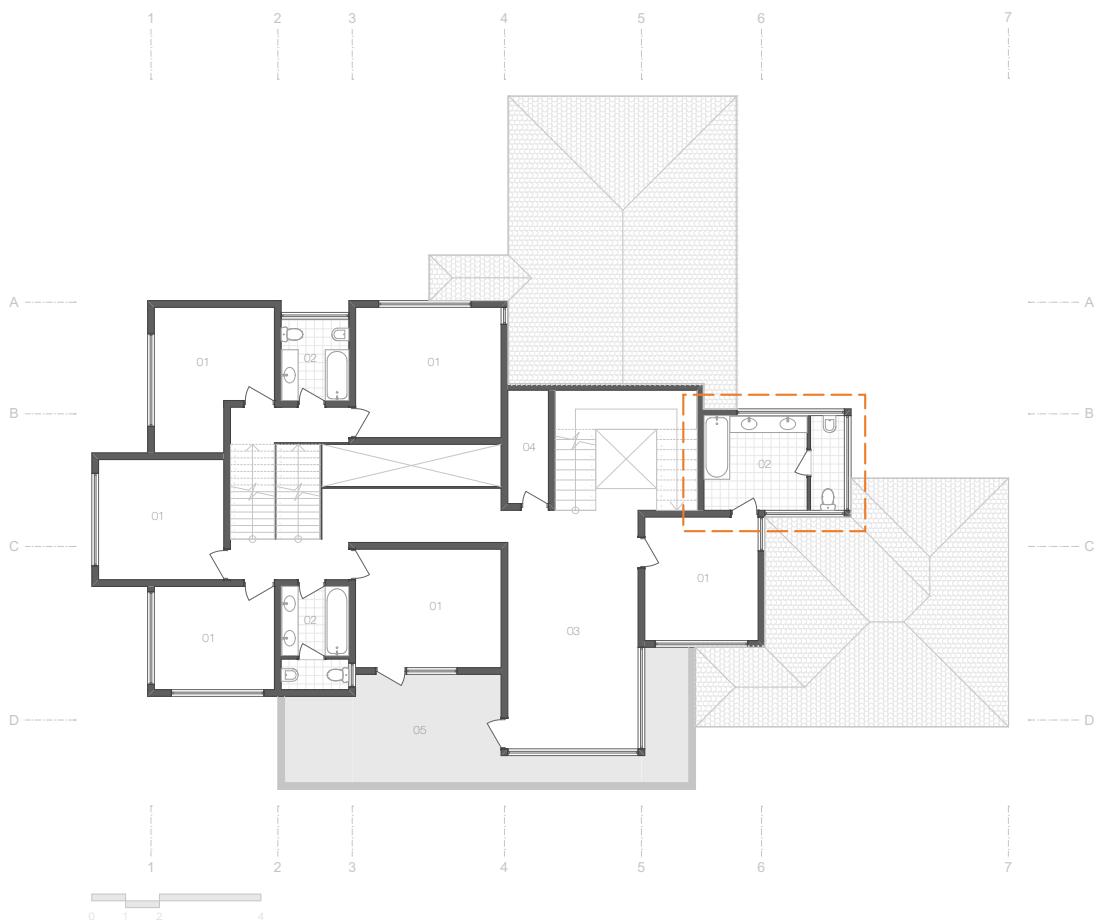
Vivienda Schneewind Tosi Planta Alta
